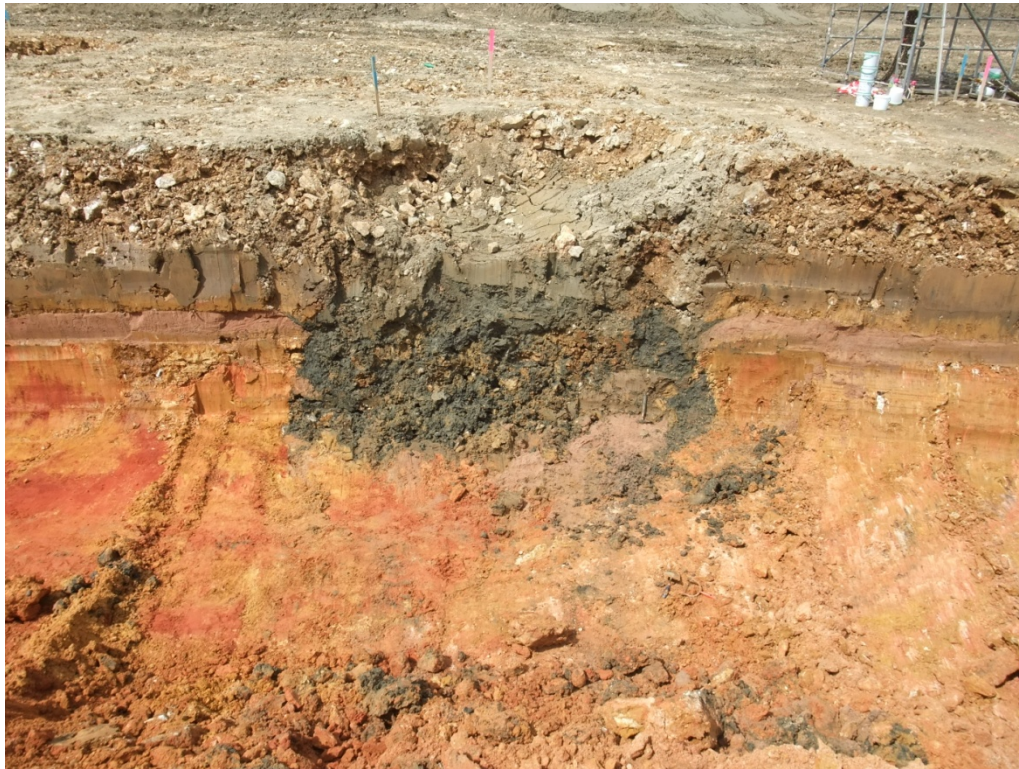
Aushub -2,3 m, Ansicht Einbruchtrichter 3 im Anschnitt
